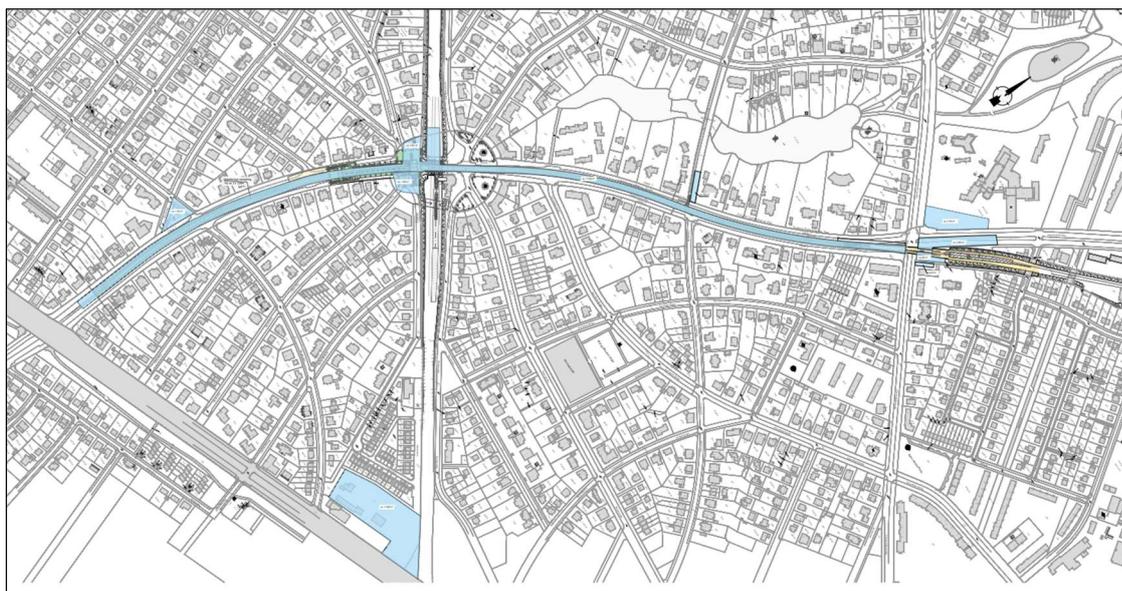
Auszug aus Lageplan – Übersichtsplan Baustelleneinrichtung (blaue Flächen)
